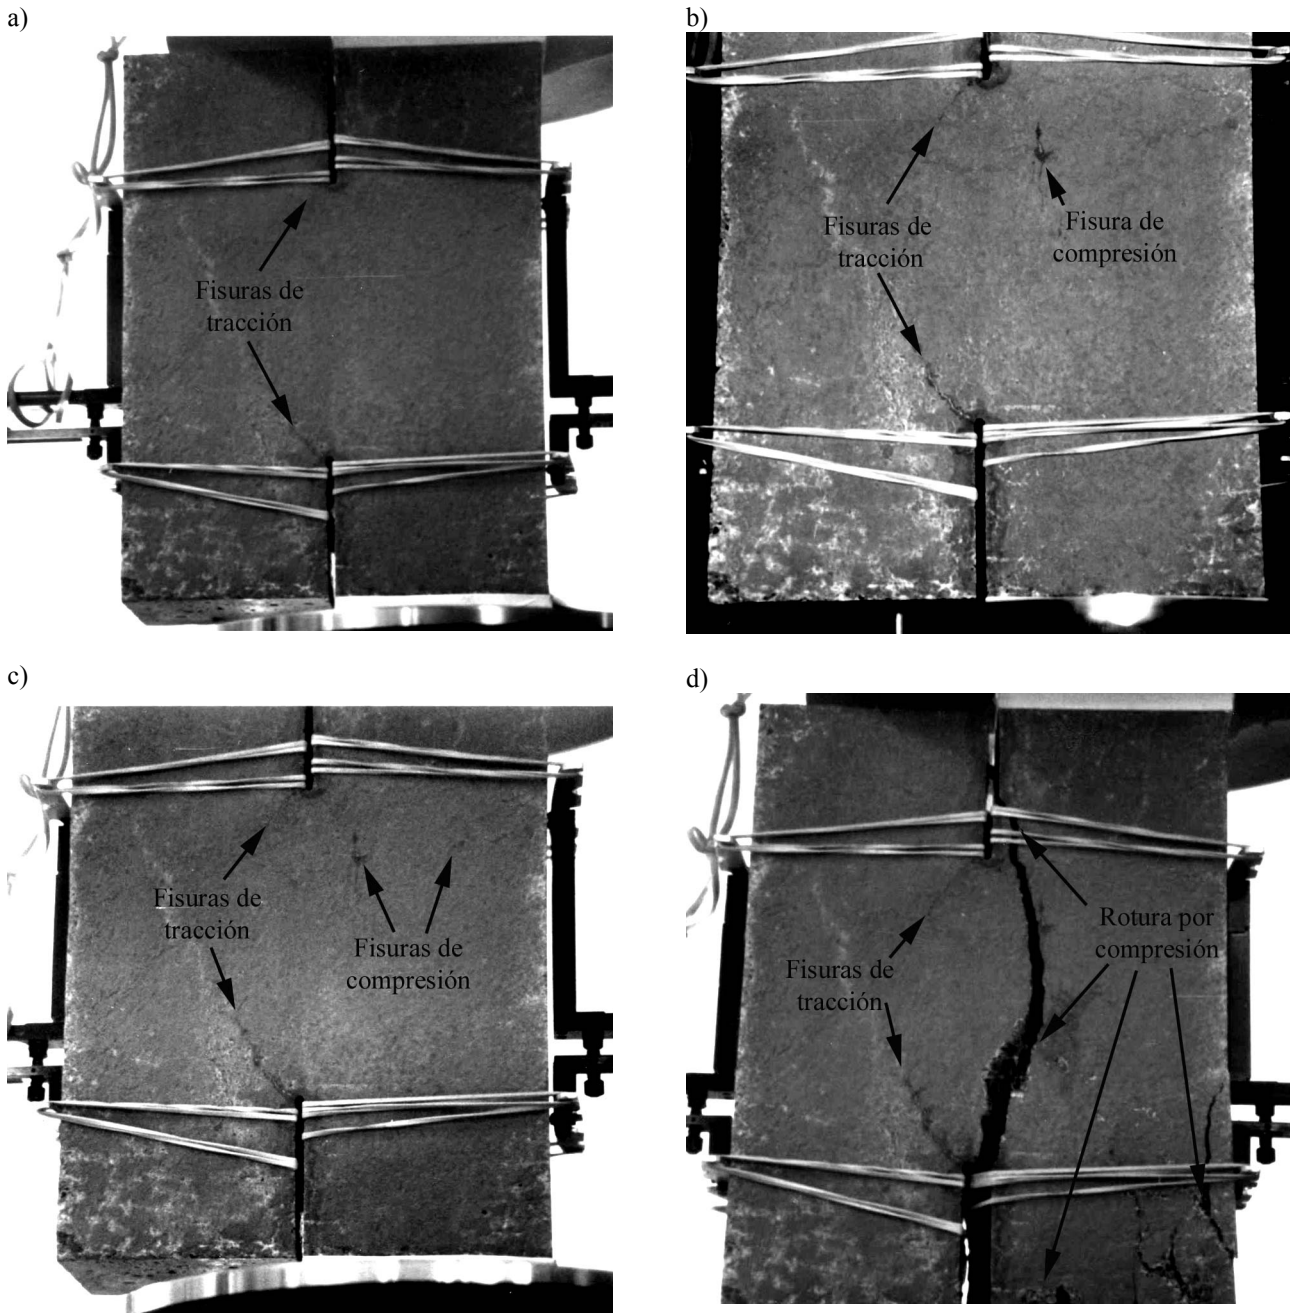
Secuencia de cuatro fotos de la cara espolvoreada con fluoresceína en el ensayo de una probeta de hormigón: a) aparición de las primeras fisuras de tracción, b) aparición de la primera fisura de compresión, c) aparición más fisuras de compresión, d) colapso y estado final de la probeta (las fisuras de tracción apenas han avanzado, mientras que en la zona de compresión se ha roto la probeta formando el equivalente al cono de rotura de las probetas cilíndricas).
